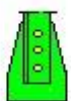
détails sur l'assemblage au gousset barre simple.
